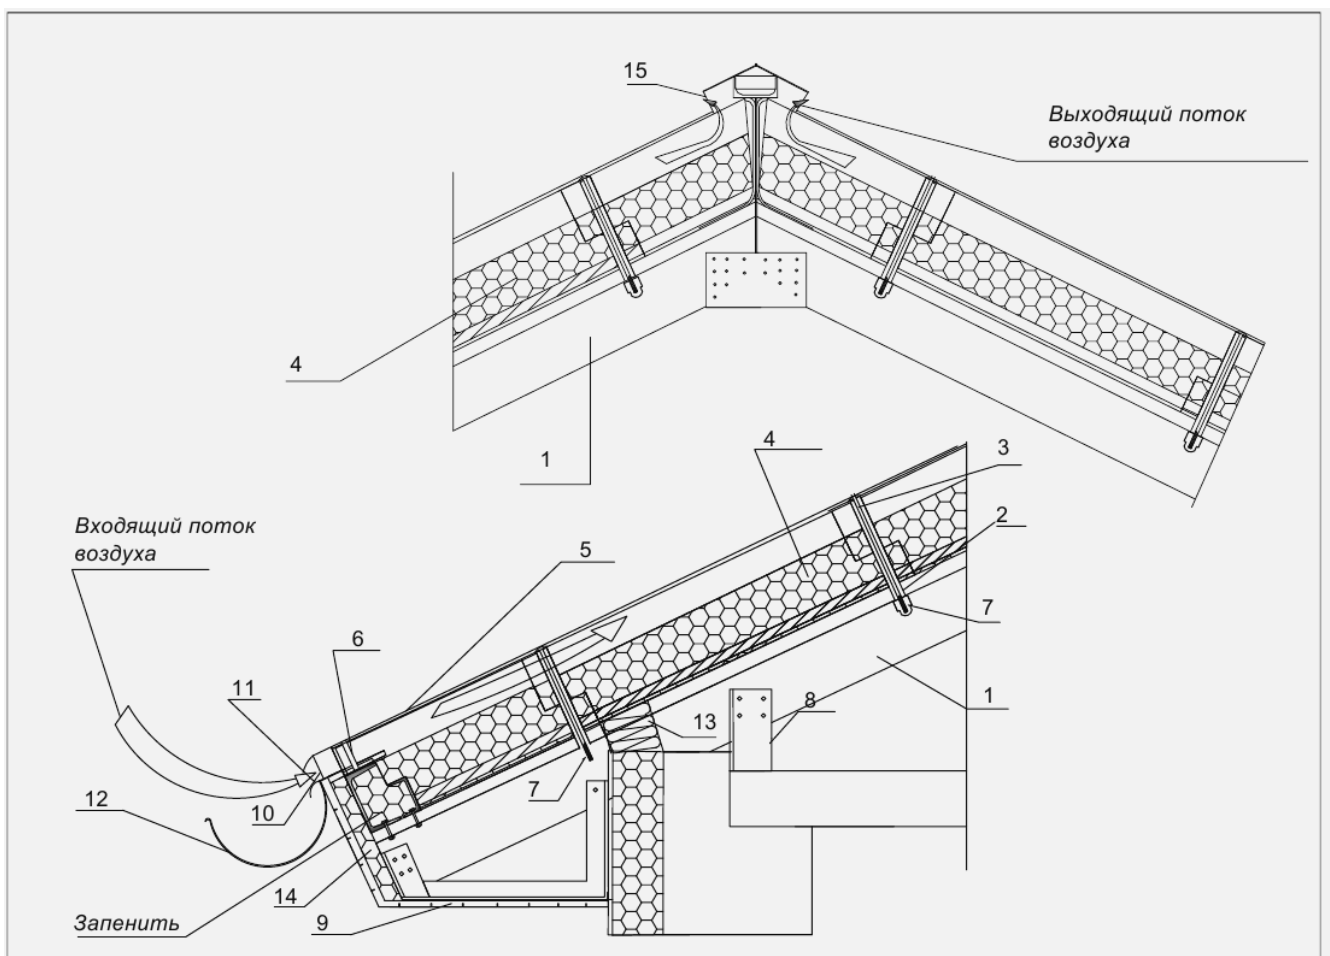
Карнизный свес закрытого типа вентилируемой кровли с установкой на металлические стропила:
